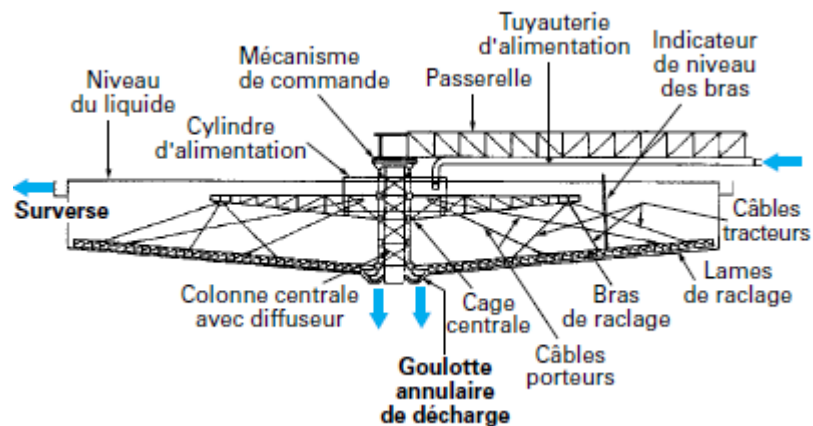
Coupe verticale d'un décanteur à traction par câbles
